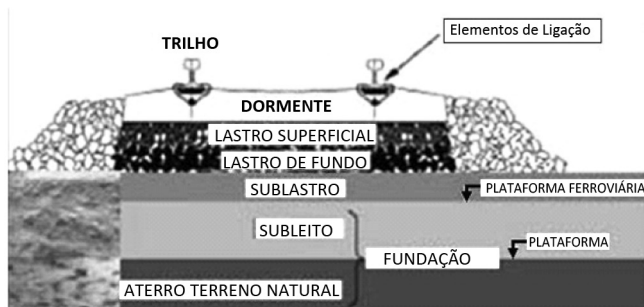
Sistema estrutural do pavimento ferroviário (adaptado de SELIG e WATERS, 1994).
